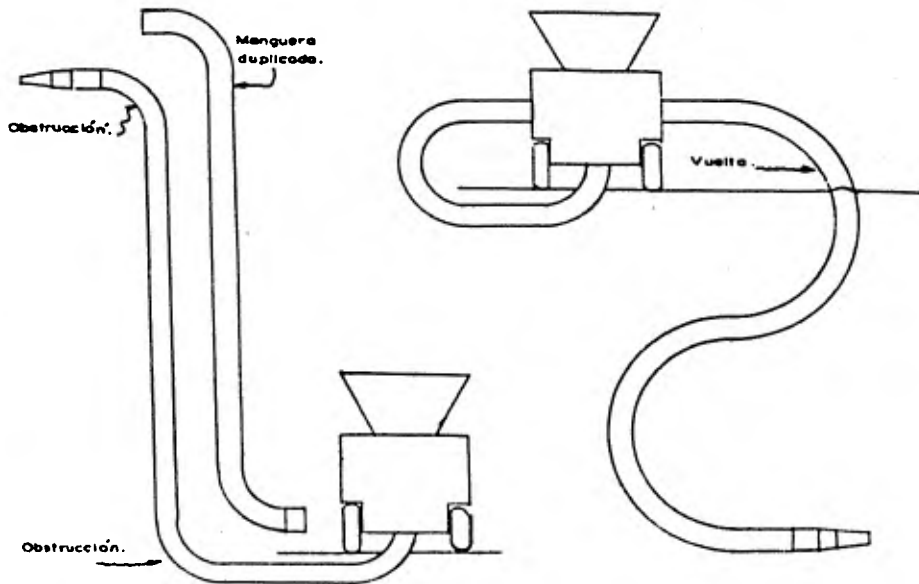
Colocación superior e inferior del concreto lanzado.
